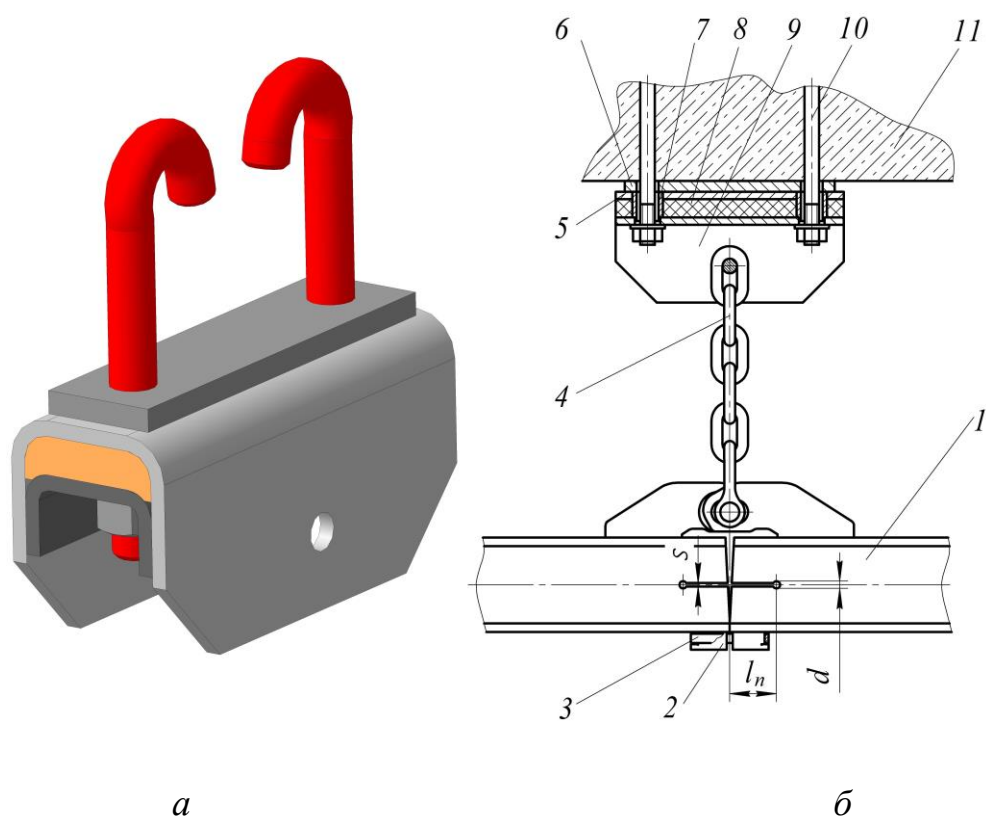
Модернизированный стык монорельсового пути: *а* – общий вид опоры подвески для арочной крепи; *б* – схема подвески для анкерной крепи, где *1* – монорельс; *2* – штифт с выступом; *3* – прижимное кольцо; *4* – цепь; *5* – корпус опоры; *6* – металлическая пластина; *7* – втулка; *8* – эластичная вставка; *9* – скоба опоры; *10* – анкер; *11* – кровля горной выработки
